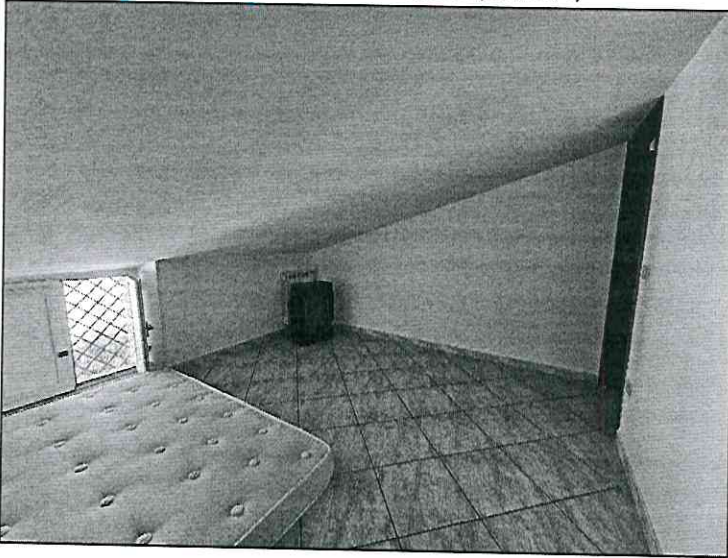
Piano Secondo - Interni (Ripostiglio)
